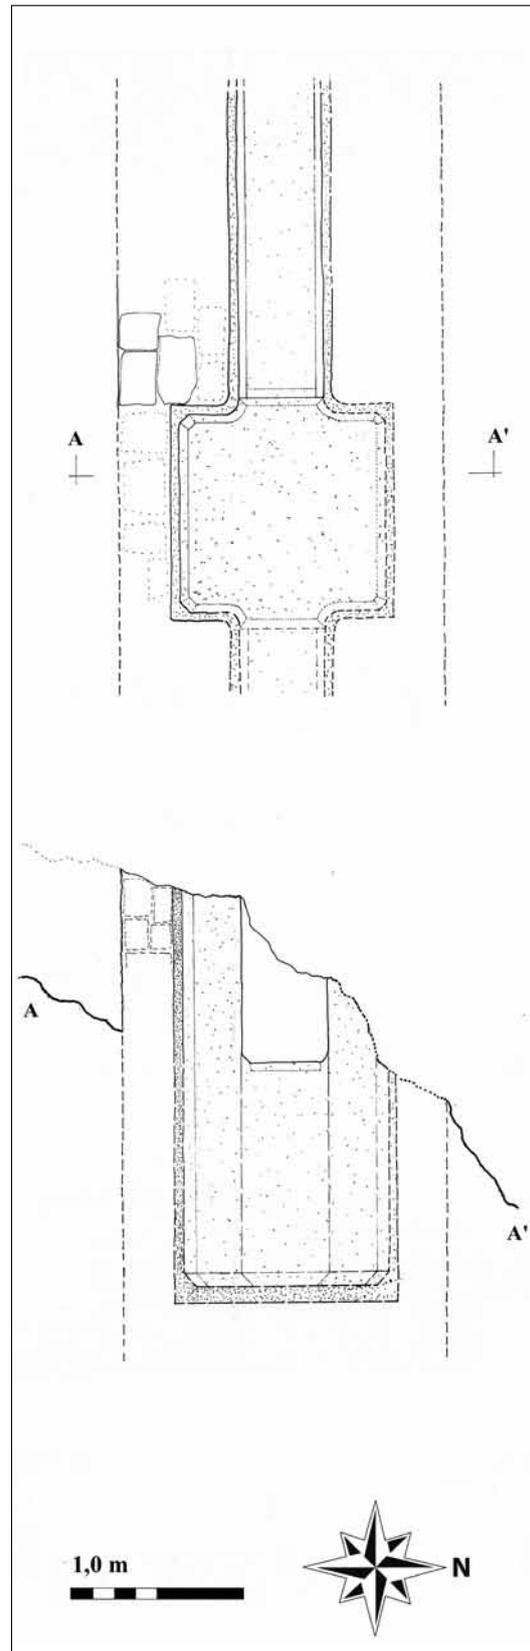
Particolare del tratto di condotto 4.3; tratto di condotto 4.3, pianta e sezione del pozzo d'ispezione (disegno A. Chighine).
